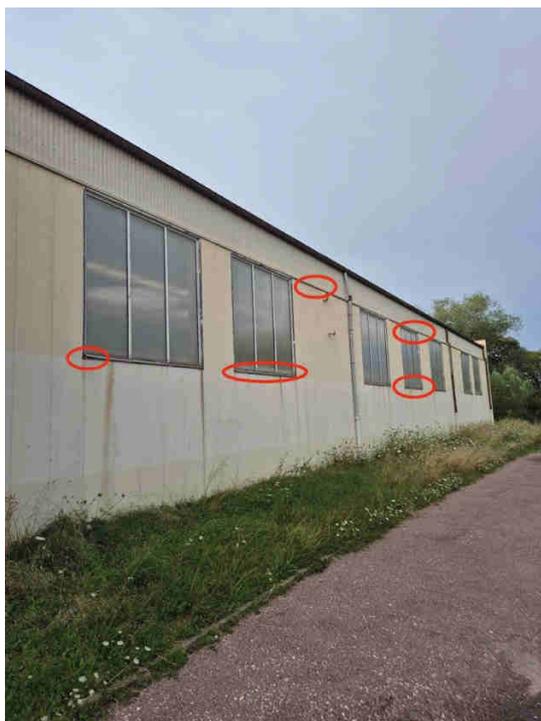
Localisation des sorties de gîte au niveau des fenêtres et revêtement sur la façade sud
